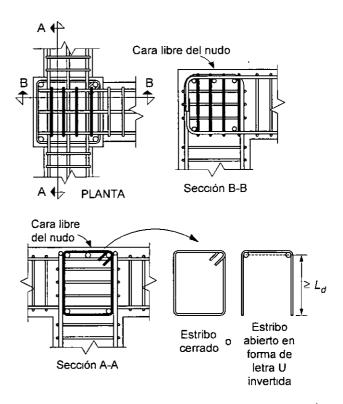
Refuerzo transversal vertical en uniones viga – columna
